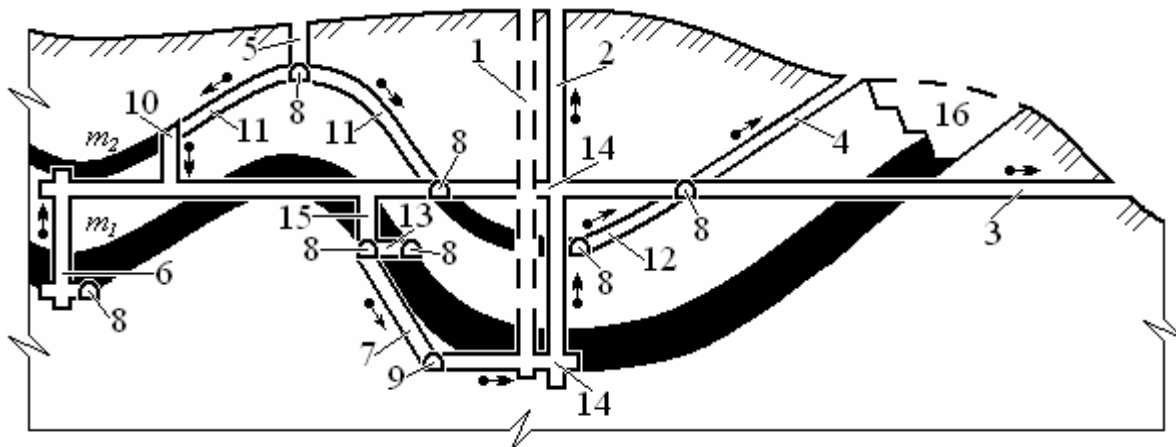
Схема угольной шахты (разрез вкрест простирания):
